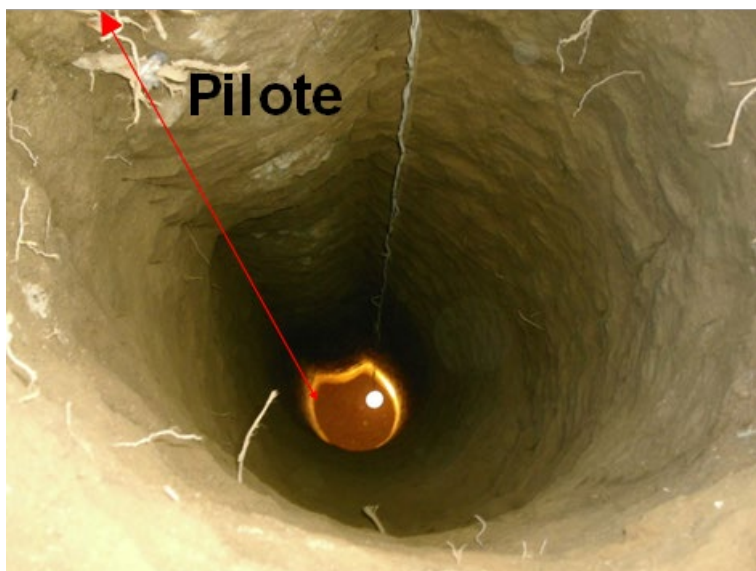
Inspección de un pilote. Ausencia de campana prevista en proyecto
